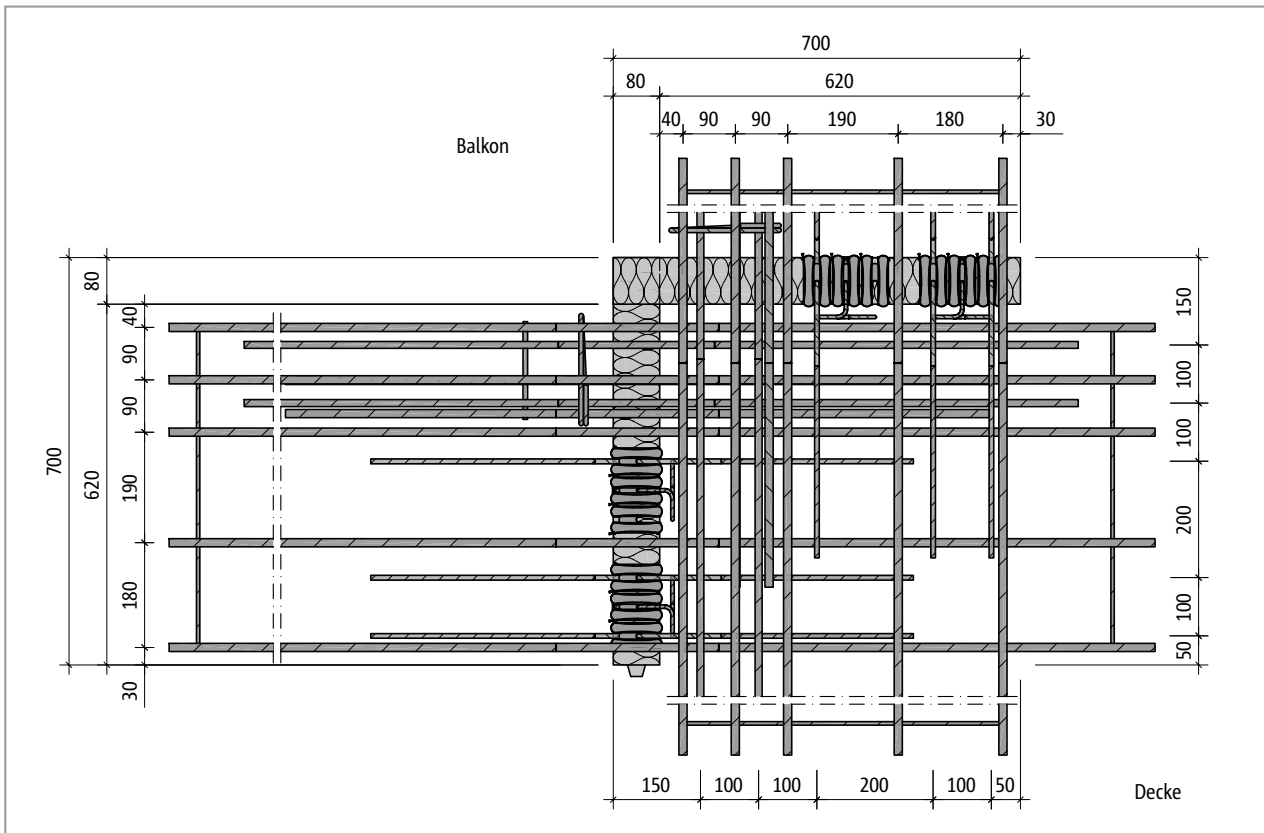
Schöck Isokorb® T Typ C-M2: Produktgrundriss
